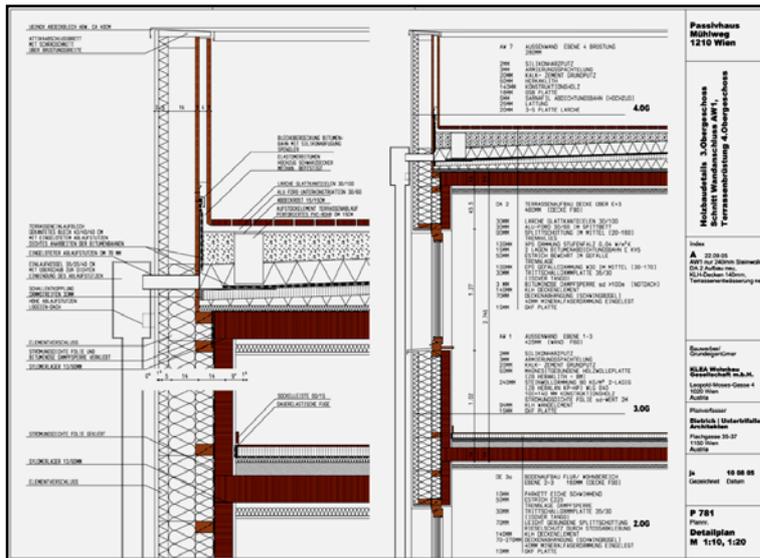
Passivhaus Mühlweg - Holzbau Details, Schnitt Wandanschluss
